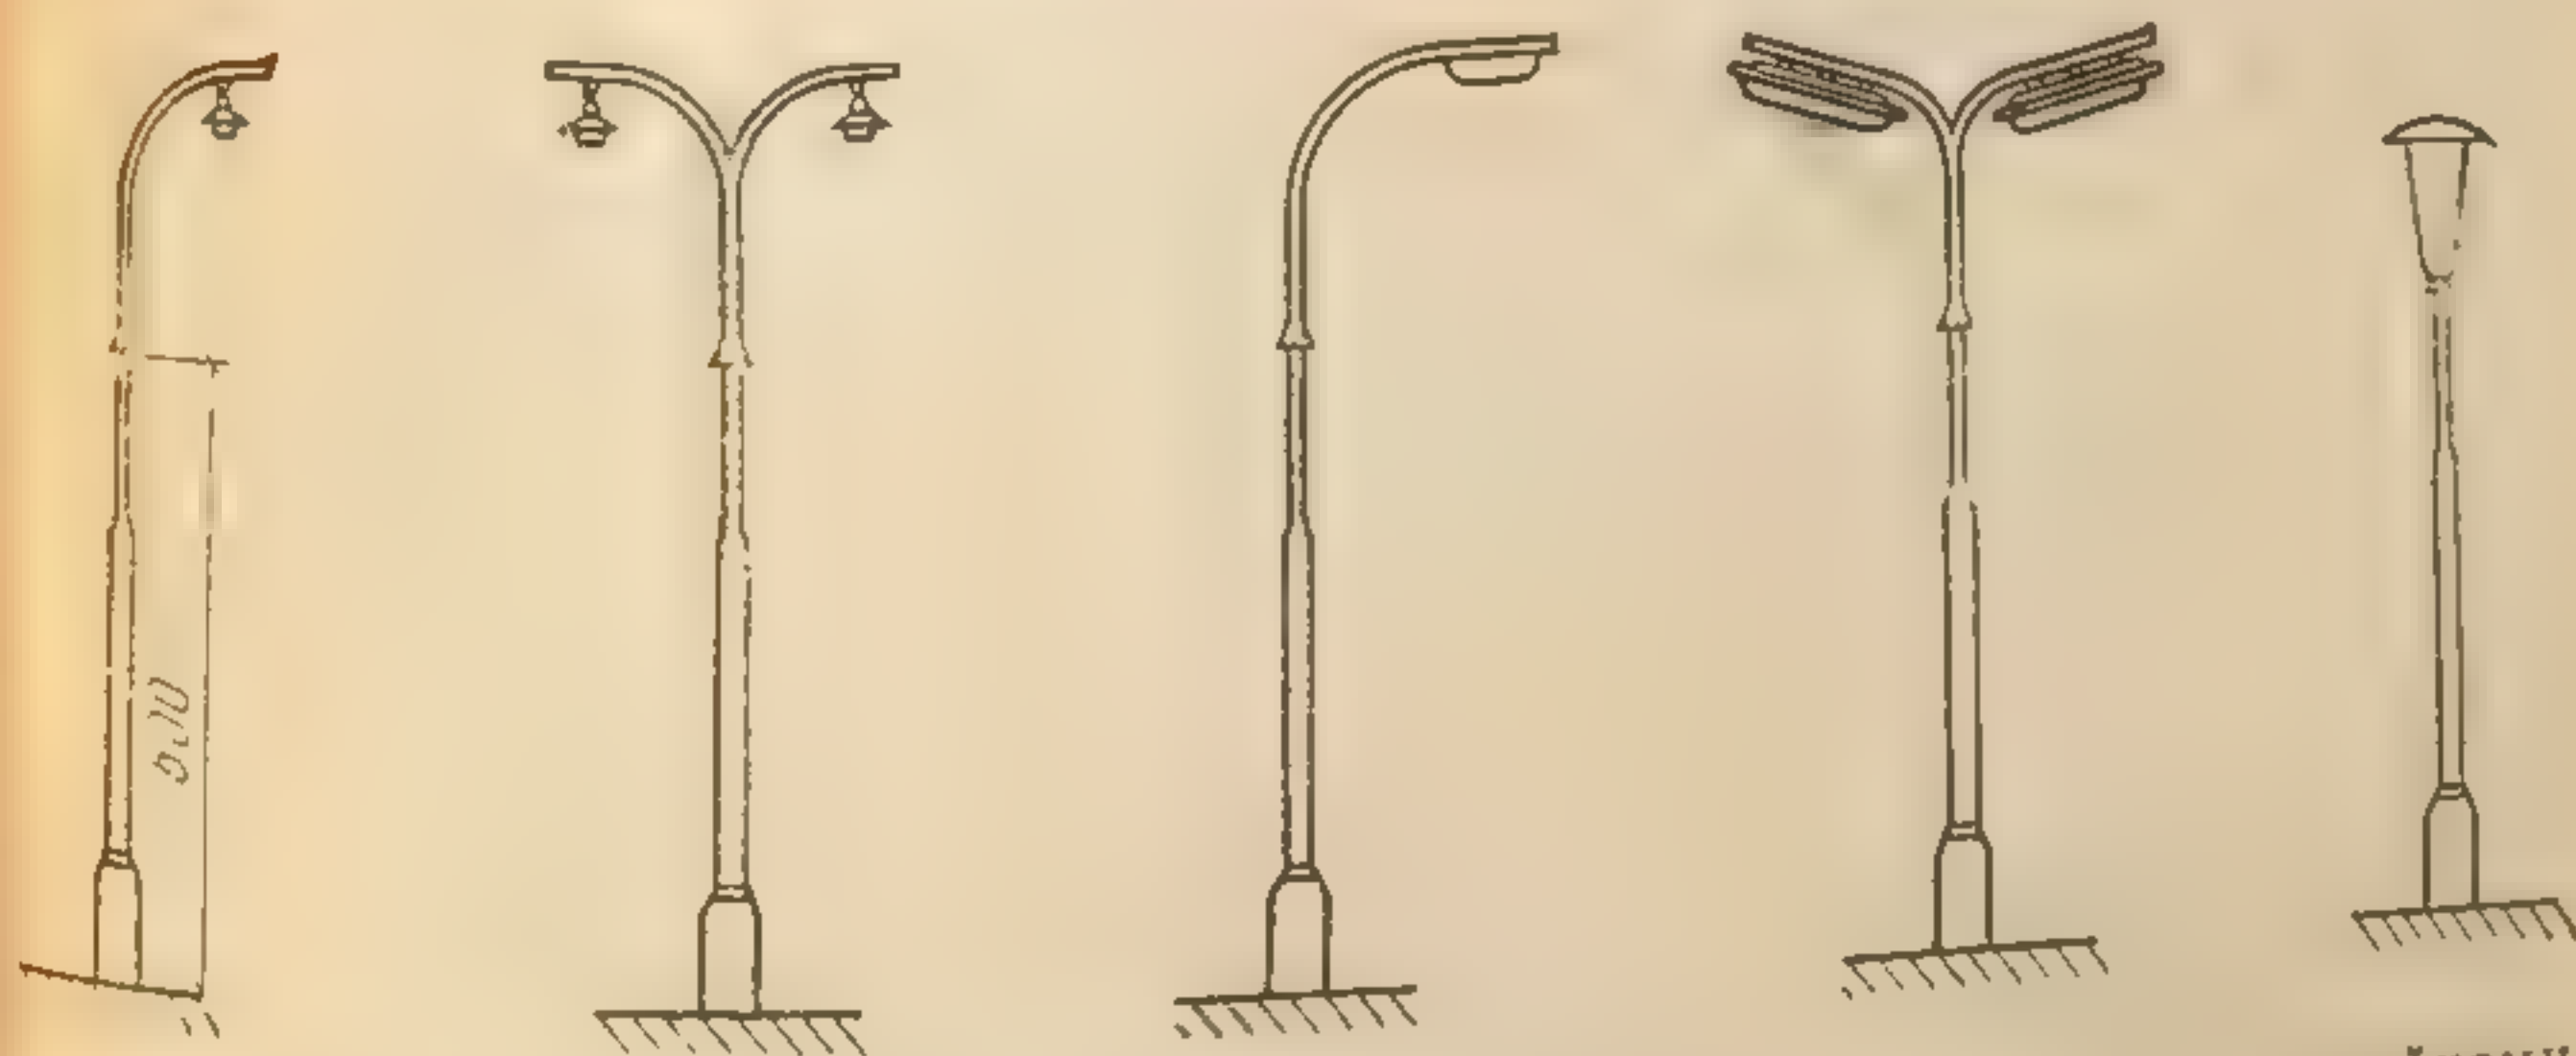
Типовые железобетонные опоры с взаимозаменяемыми кронштейнами и фонарями
